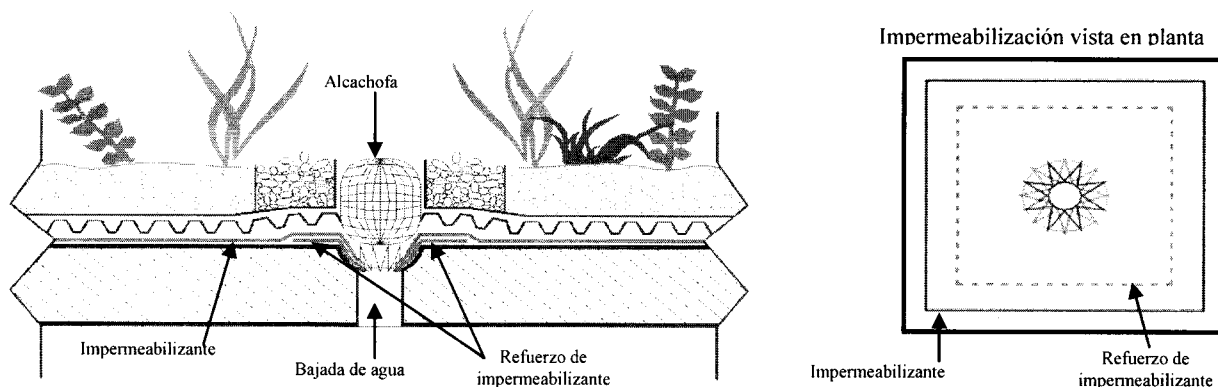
Impermeabilización y refuerzo en puntos de encuentro con bajadas de agua.
